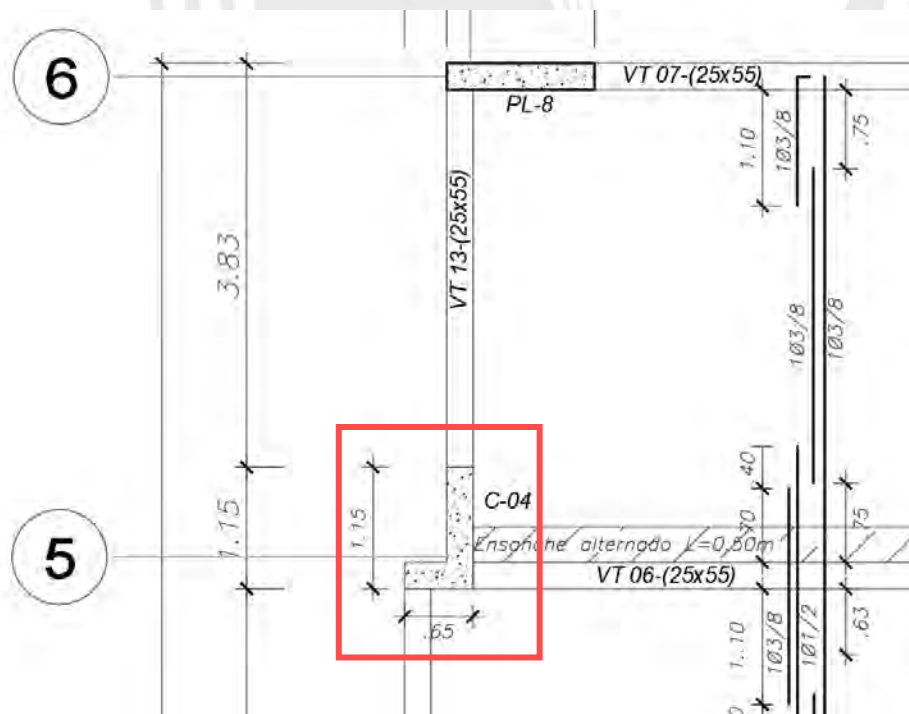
Ubicación de la columna entre los Ejes A y 5
